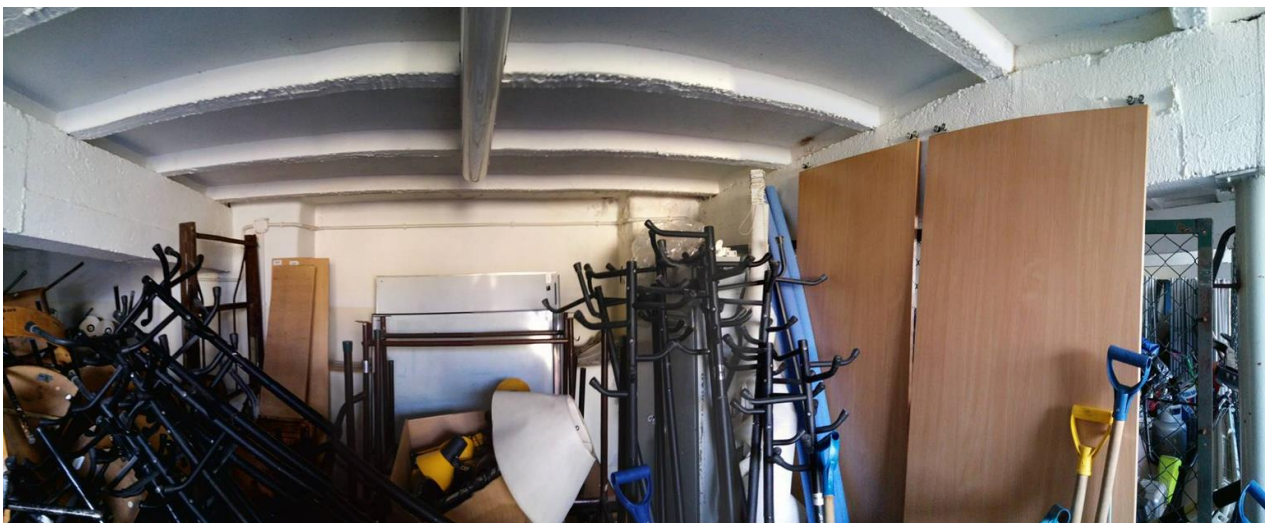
Wnętrze magazynu – widoczny dach z płyt korytkowych wsparty na dźwigarach żelbetowych
